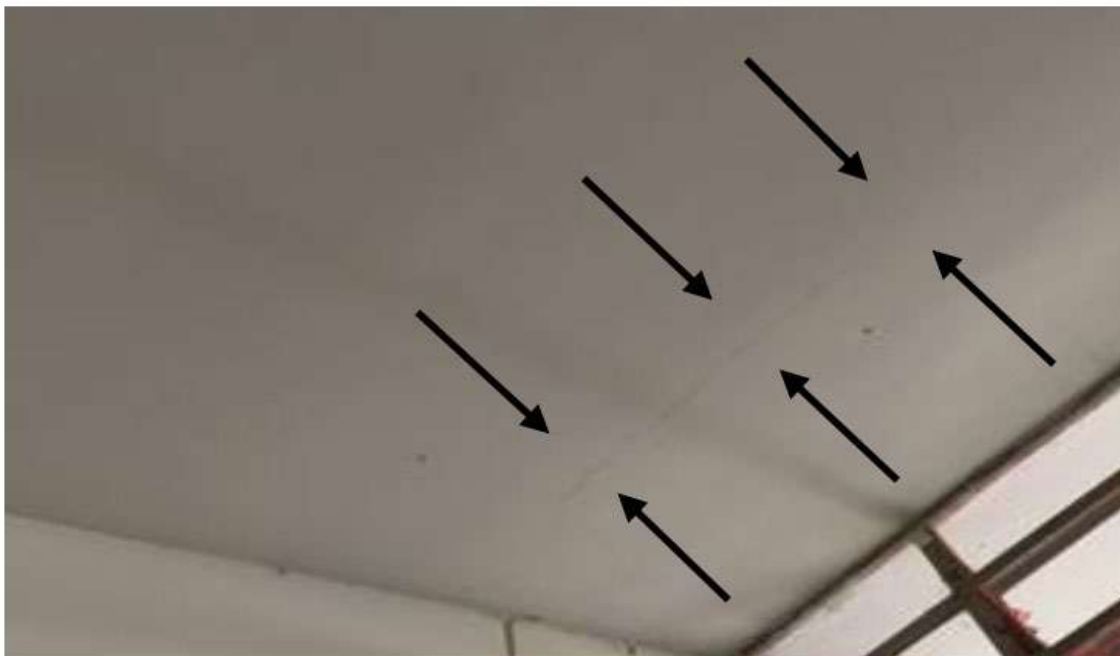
Fissura de revestimento: fissuras na laje
